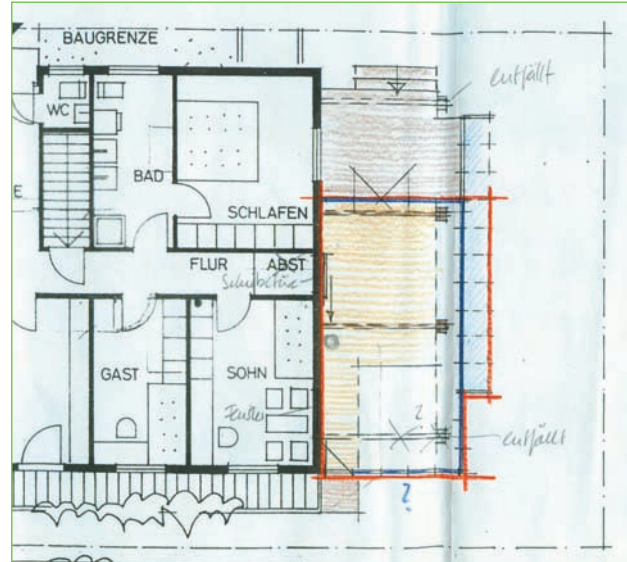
Auszug aus einem Lageplan mit eingezeichnetem Baufenster (Pfeil und rot umrandet).
